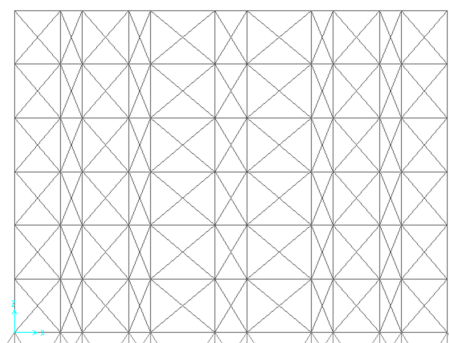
Configuração dos Planos de Contraventamento Vertical Com Elementos de Contraventamento Pequenos
